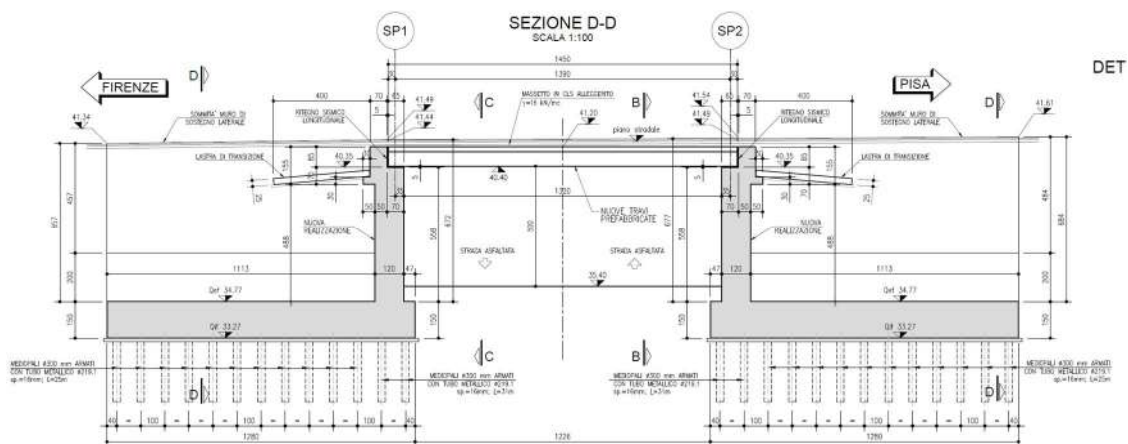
Sottovia Cantone. Sezione longitudinale sull'ampliamento
